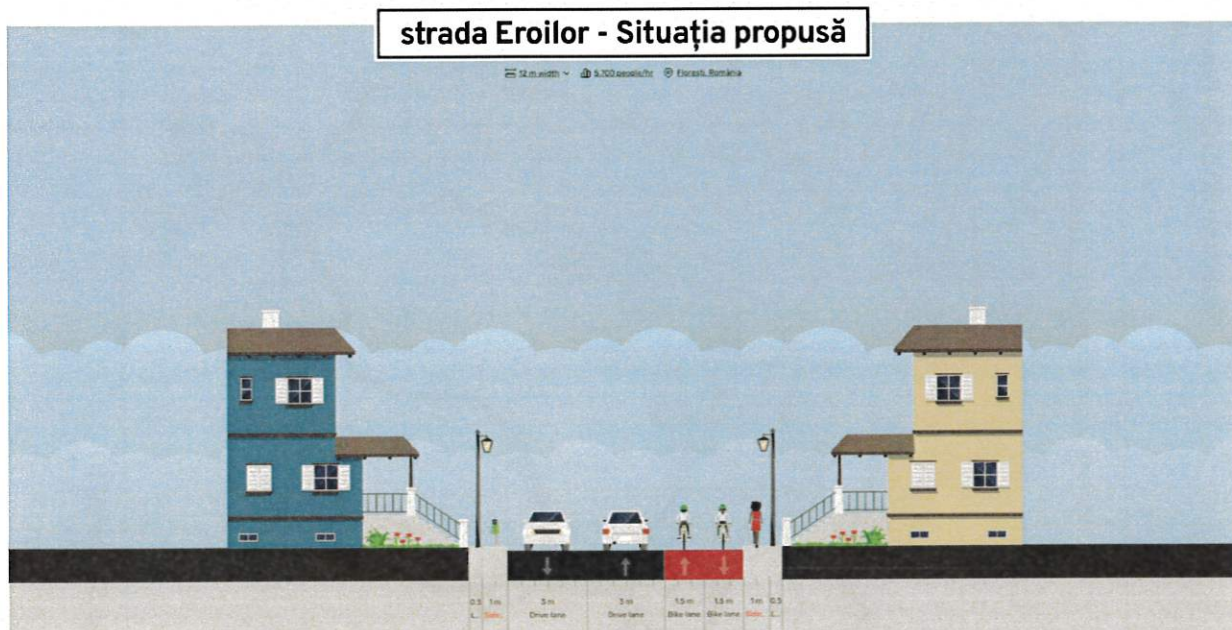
Profil transversal tip - Str. Eroilor situație propusă
